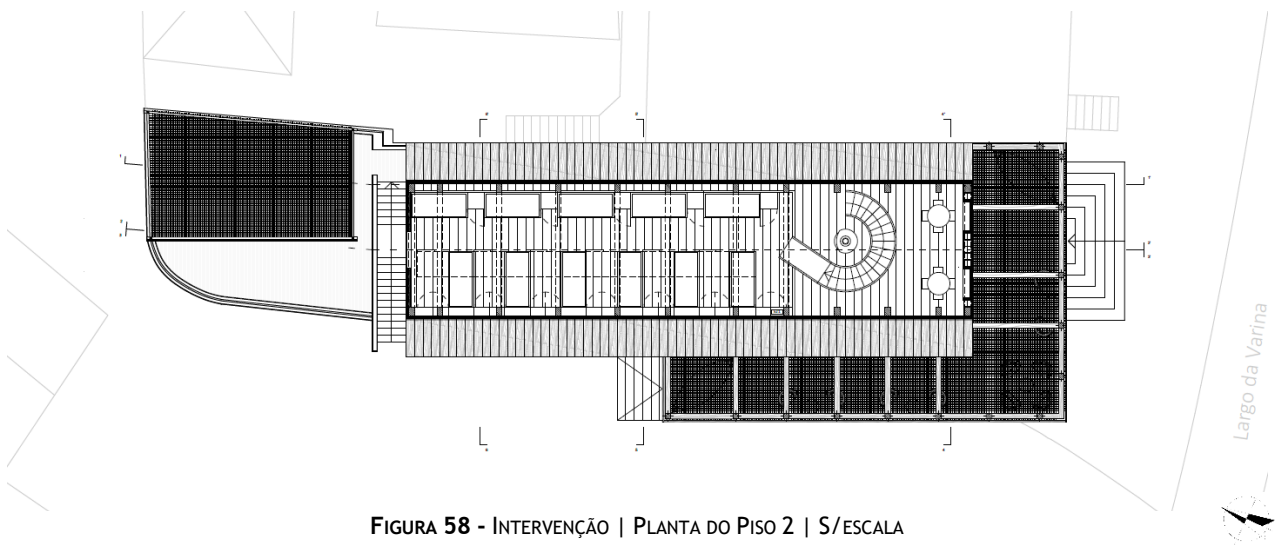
INTERVENÇÃO | PLANTA DO PISO 2 | S/ESCALA
